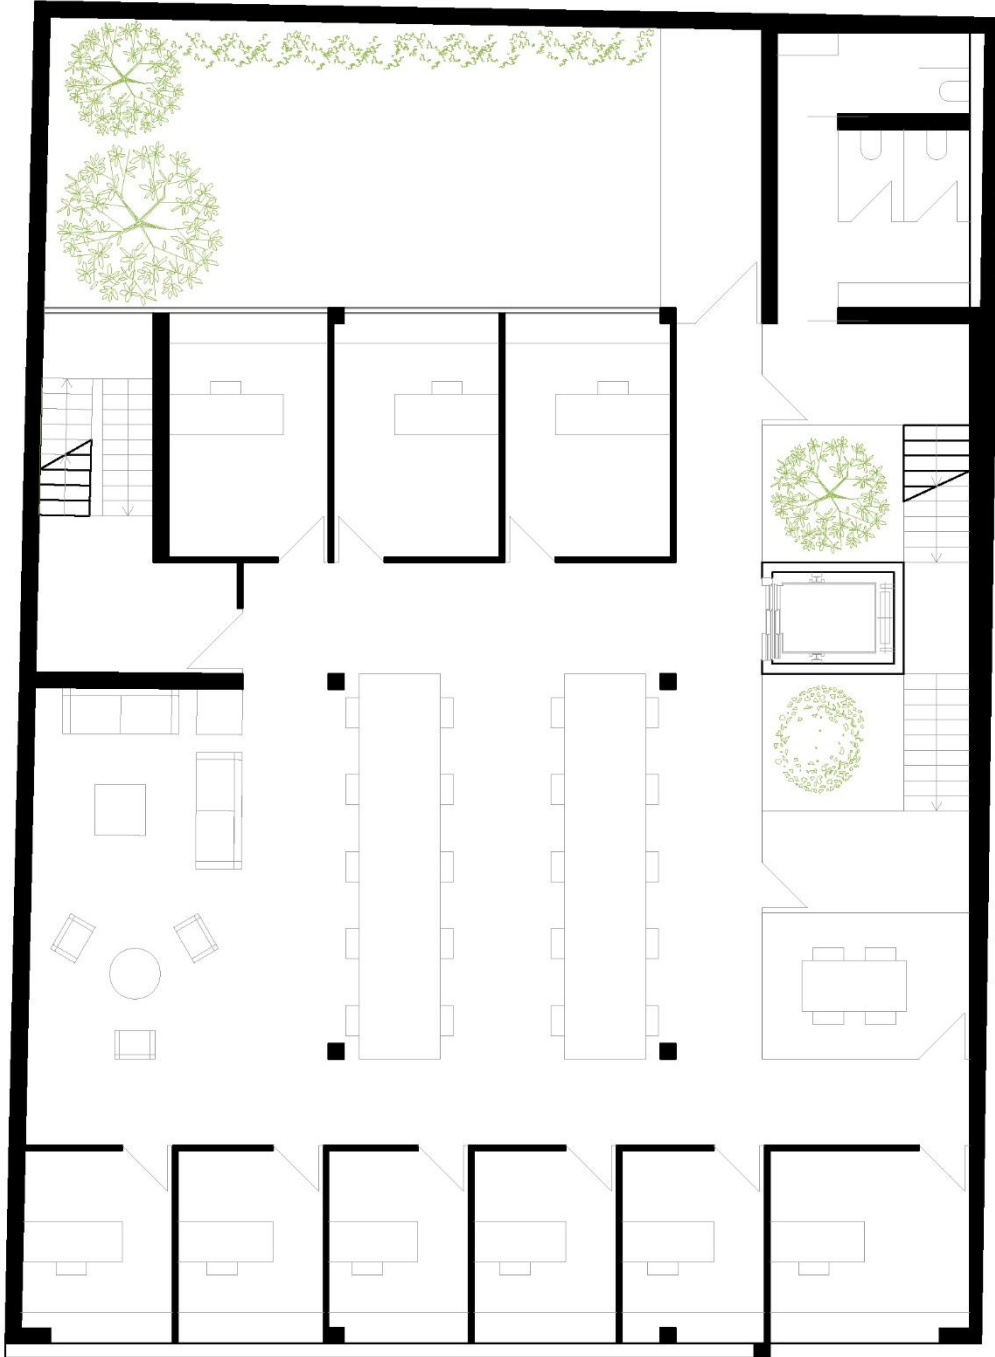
Encaje de proyecto, plantas 2,3,4. Fuente: Elaboración propia.
